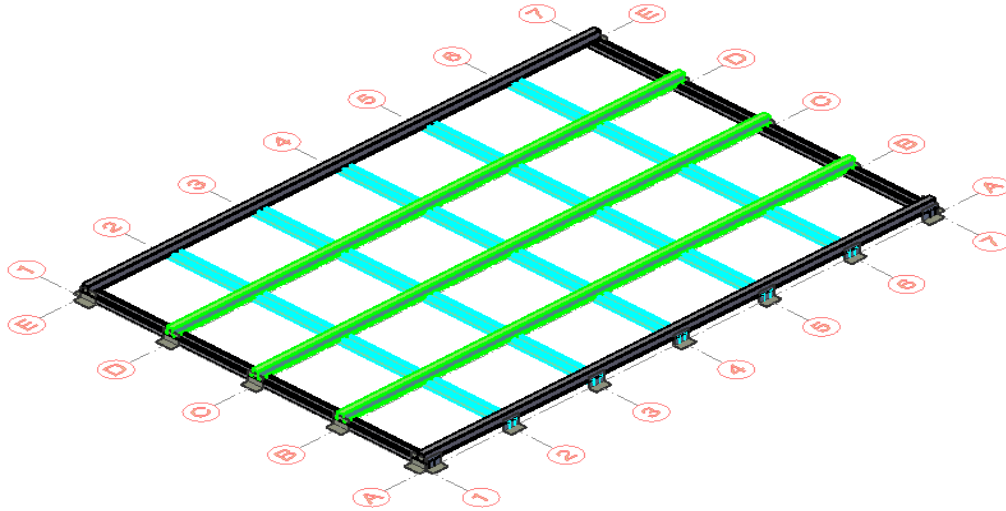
Isometría de Panel de 3.660mm x 2.460mm Colocado en Piso
